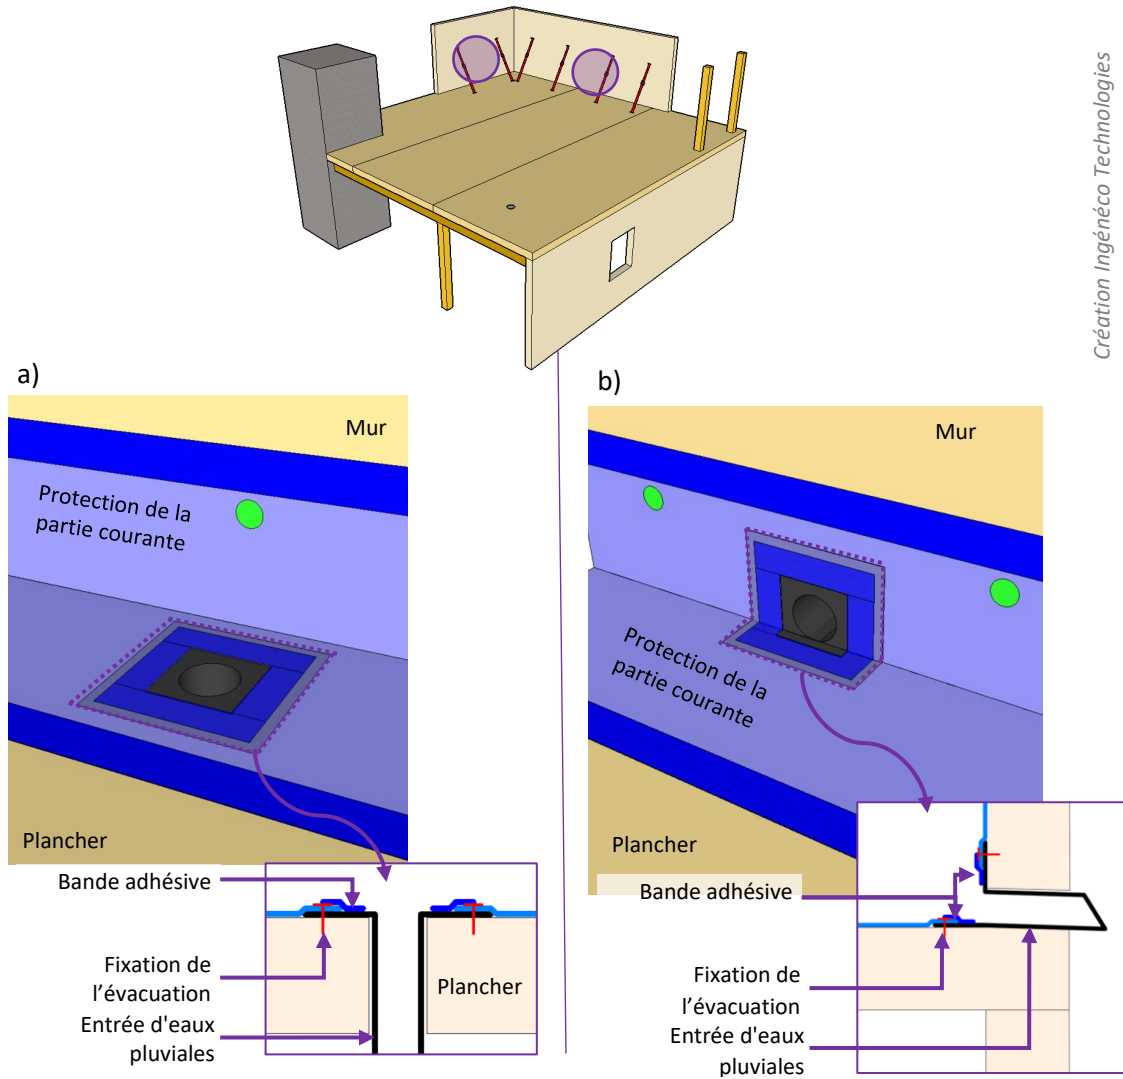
exemple d'évacuation pour les jonctions entre murs et planchers (a – évacuation au travers du plancher / b – évacuation au travers du mur)
